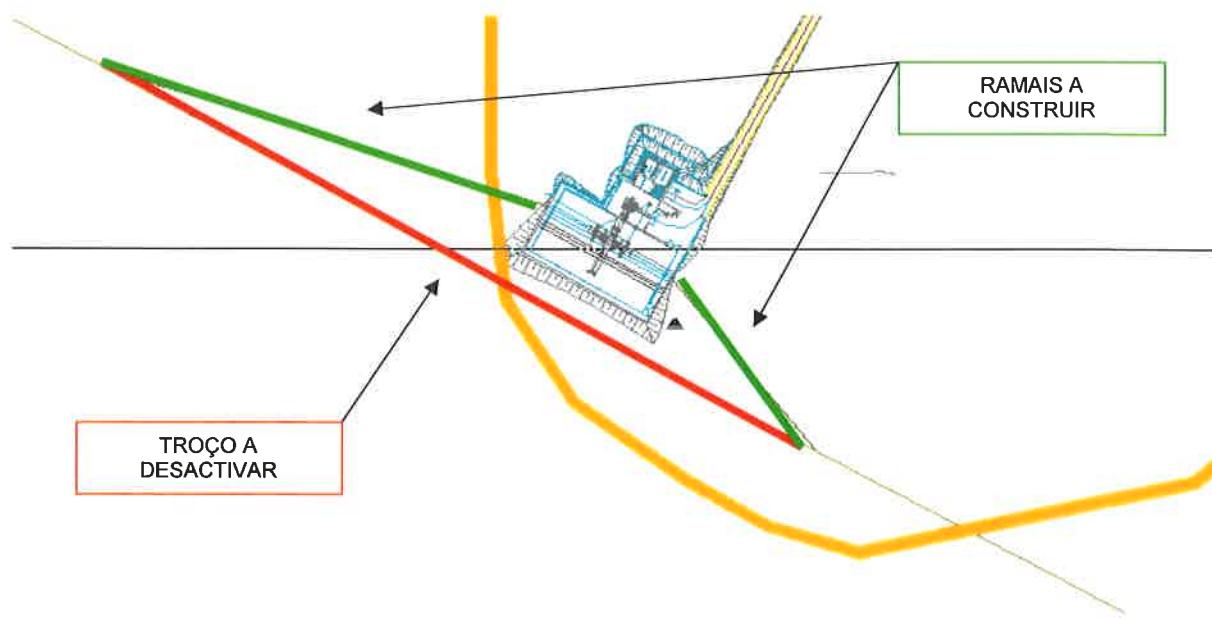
Traçado previsto para a linha eléctrica a 60 kv.
